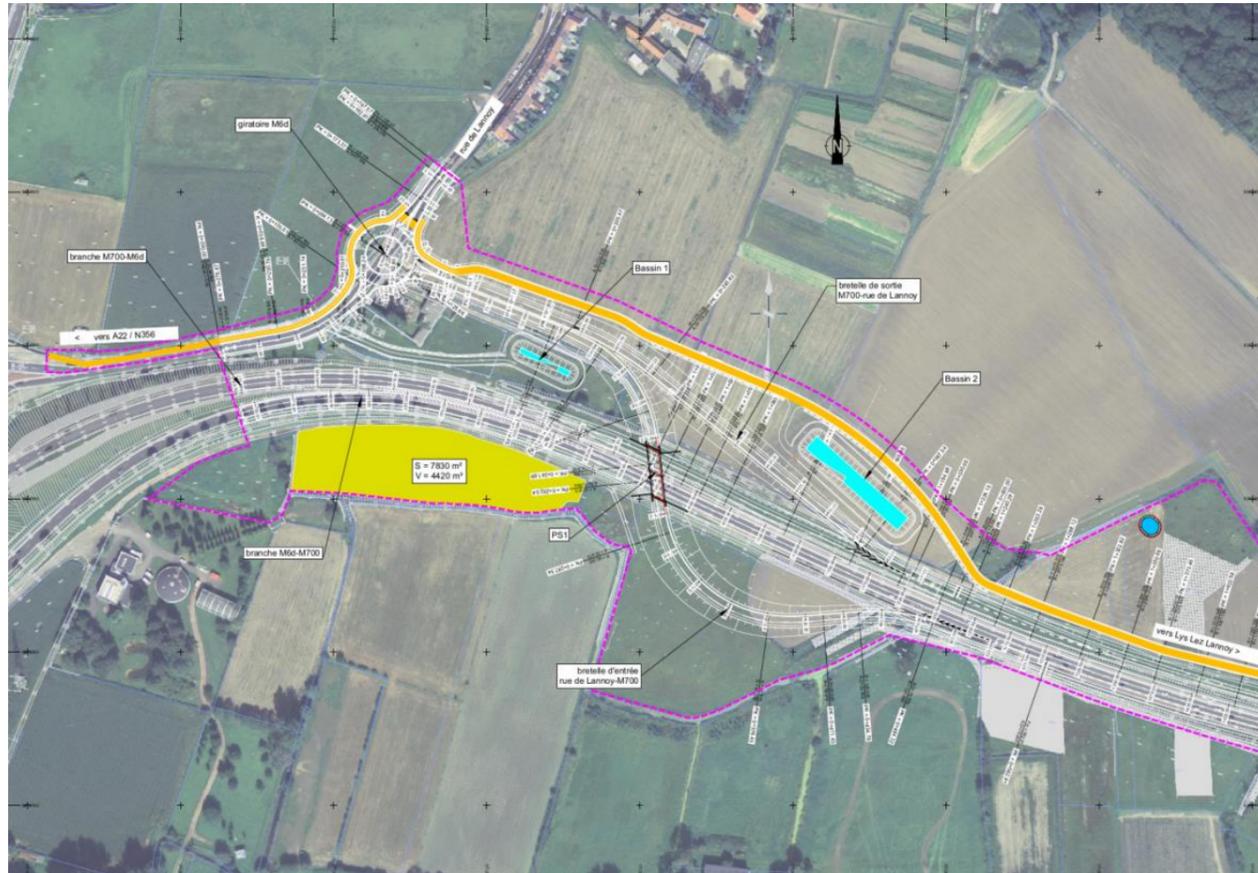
Vue en plan de la M700 au niveau de la bretelle d'accès à la M6d
